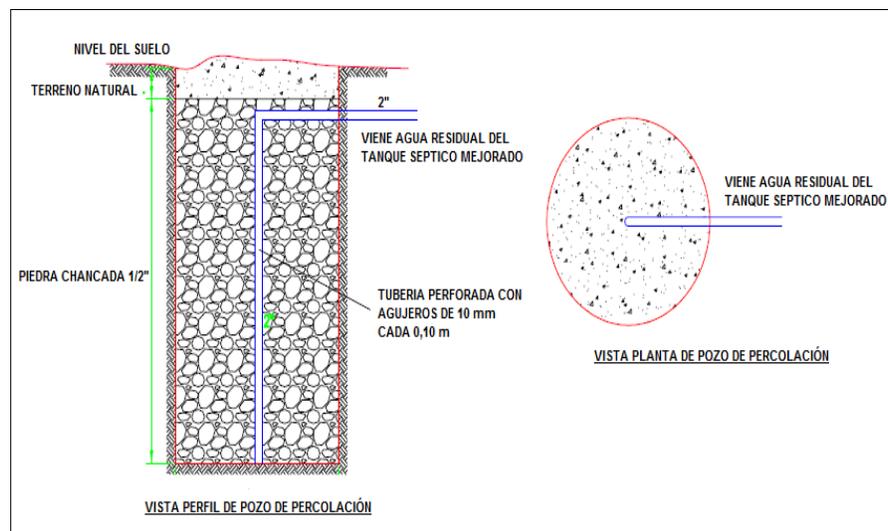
Vista en planta y corte del pozo del pozo de percolación con relleno de grava de ½”.
